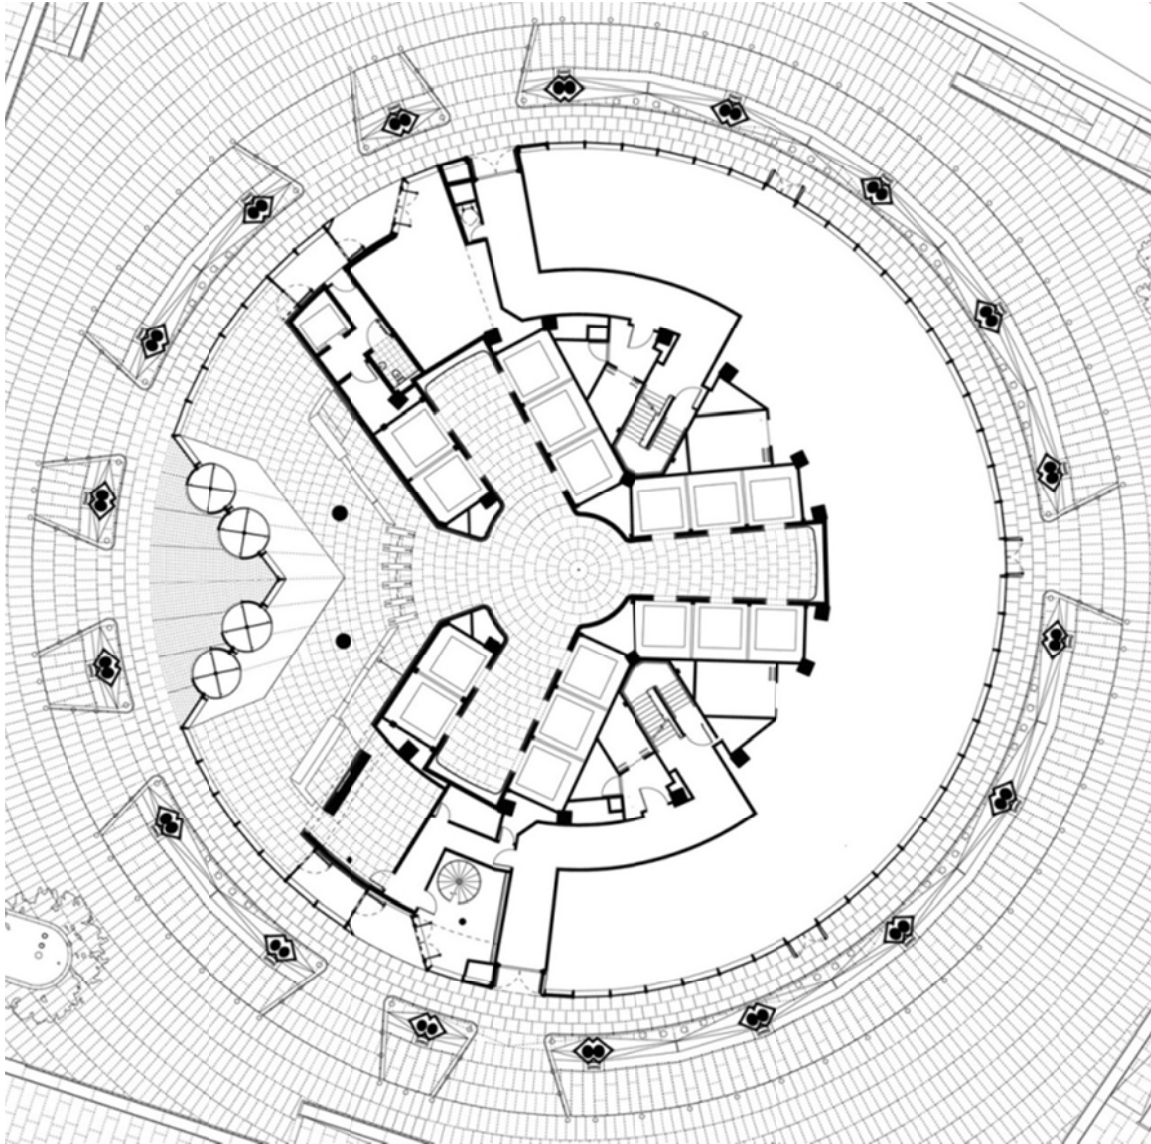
Planta de entrada de la torre Swiss Re. Puede apreciarse que hay 18 puntos dobles de apoyo de perfiles metálicos en "A" que van recubiertos de aislamiento contra el fuego y recubiertos de chapa de aluminio Fuente: © Norman Foster and Partners.
